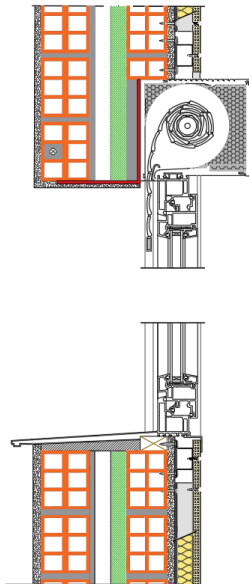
detalle de ventana (estado reformado). Fuente propia
